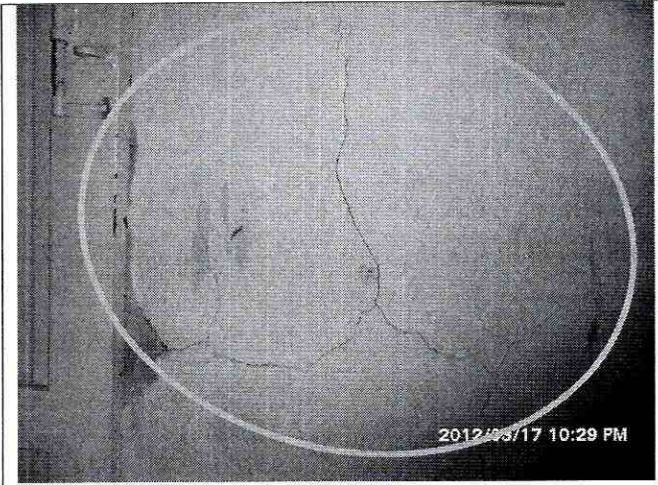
Se observan fisuras en muro del costado oriental de la puerta de acceso vehicular.
